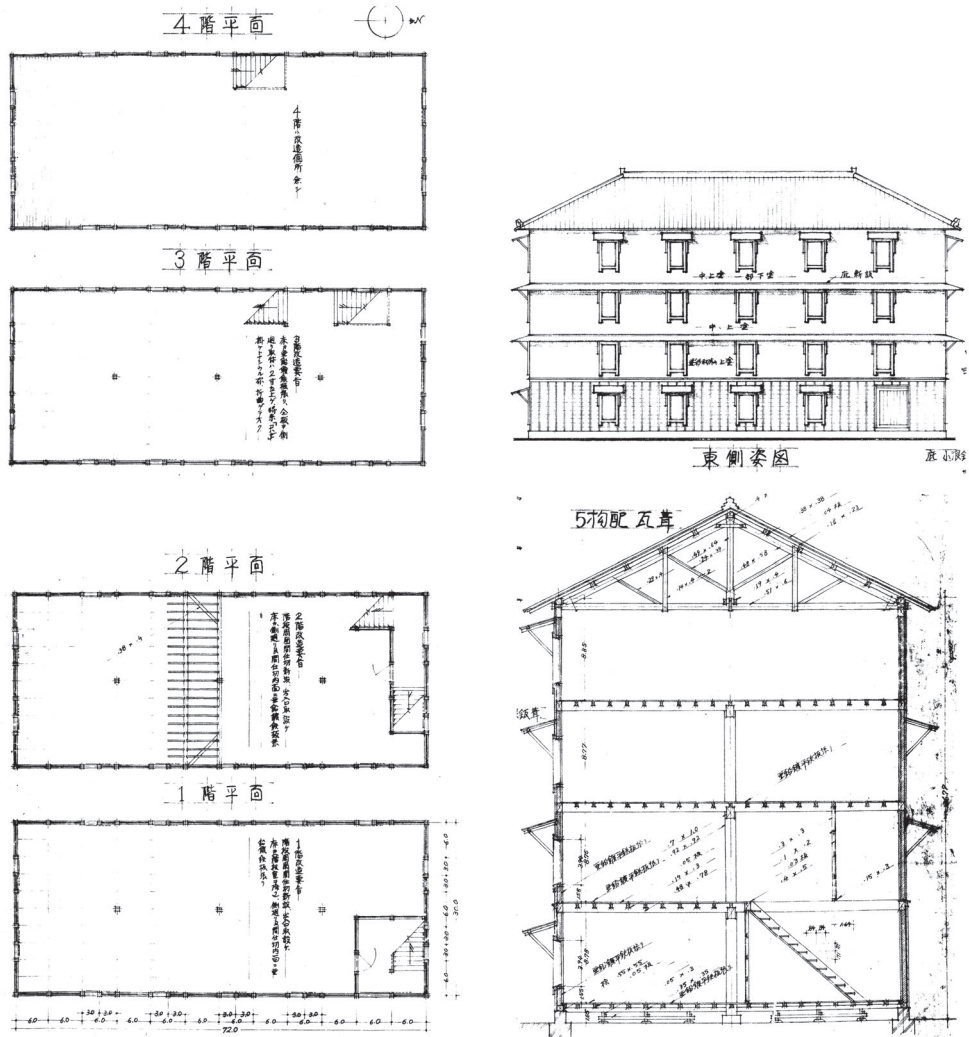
3号繭倉庫 各階平面図、東側立面図 1/400、断面図 1/200
